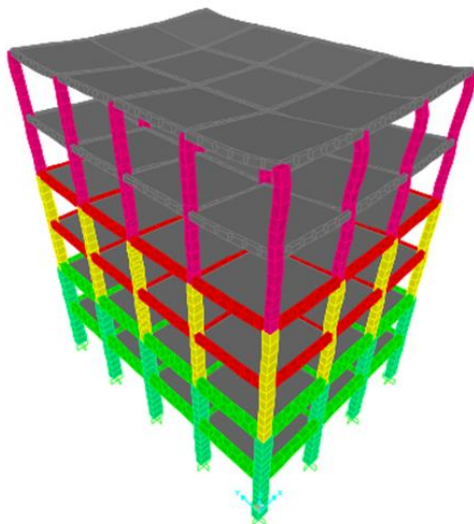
Model Struktur 3D Banguna Gedung Lantai 4
